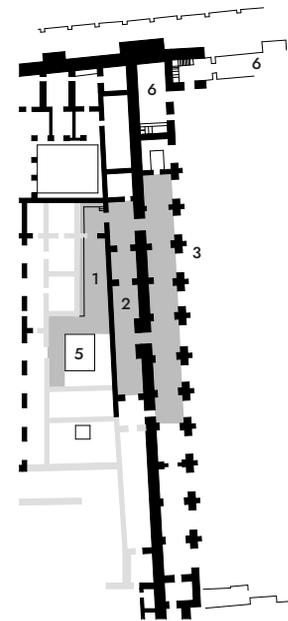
Grundrissausschnitt des Nordtors
